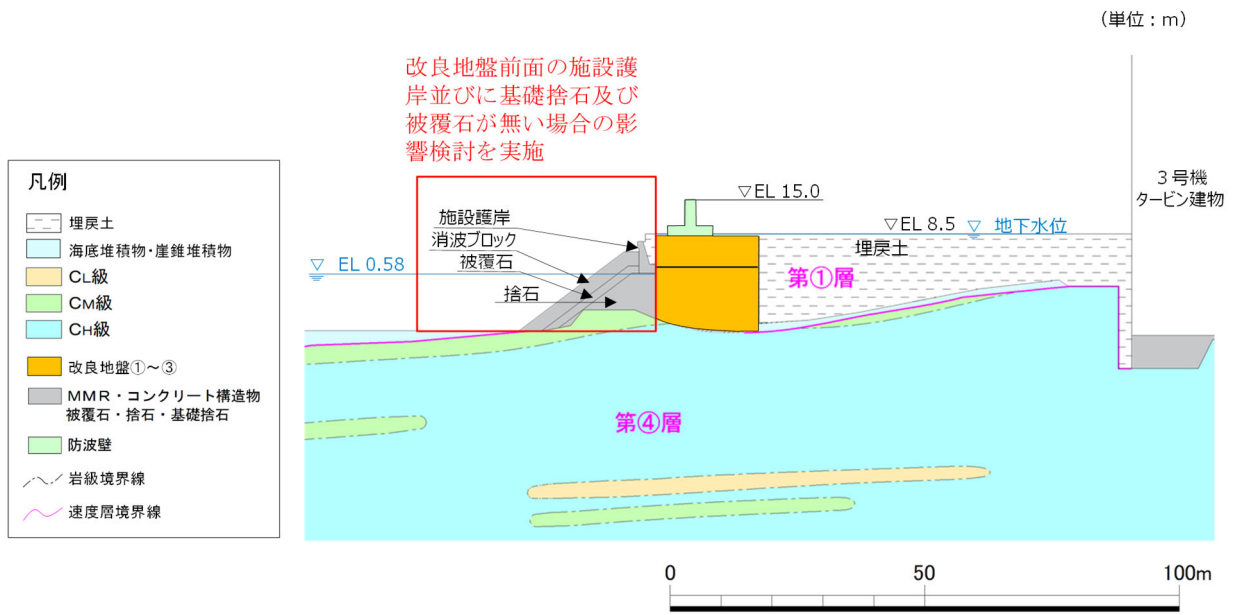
影響検討断面の地質断面図 (⑤-⑤断面)
